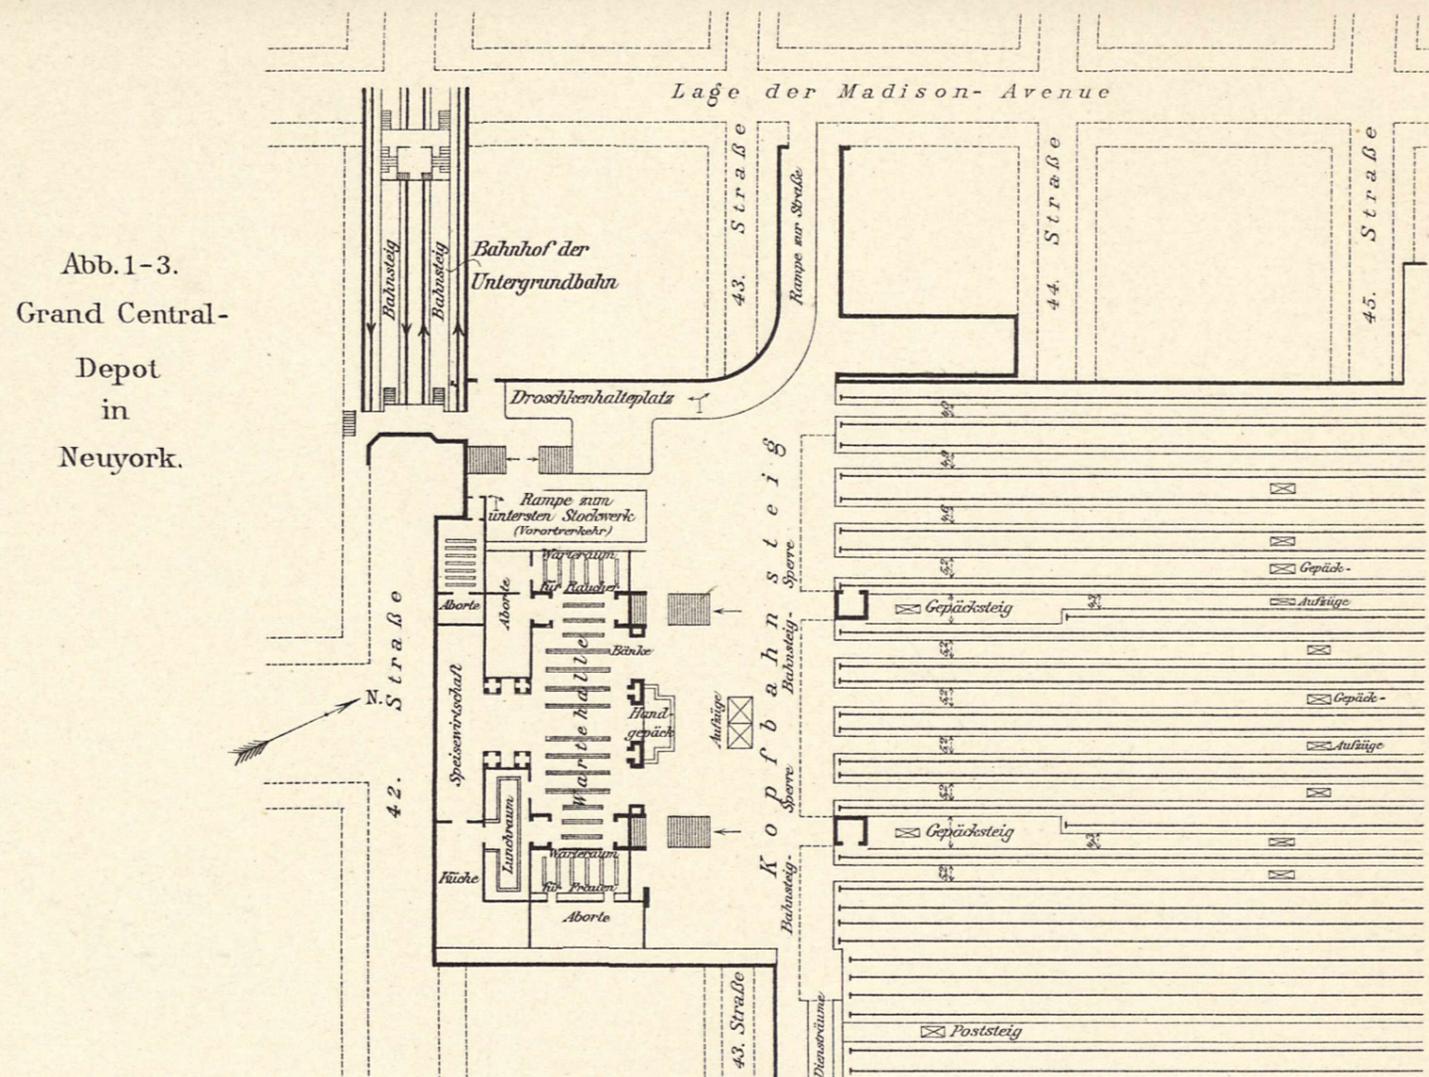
Erstes Stockwerk unter Straßengelände. Anlagen für den Fernverkehr.
